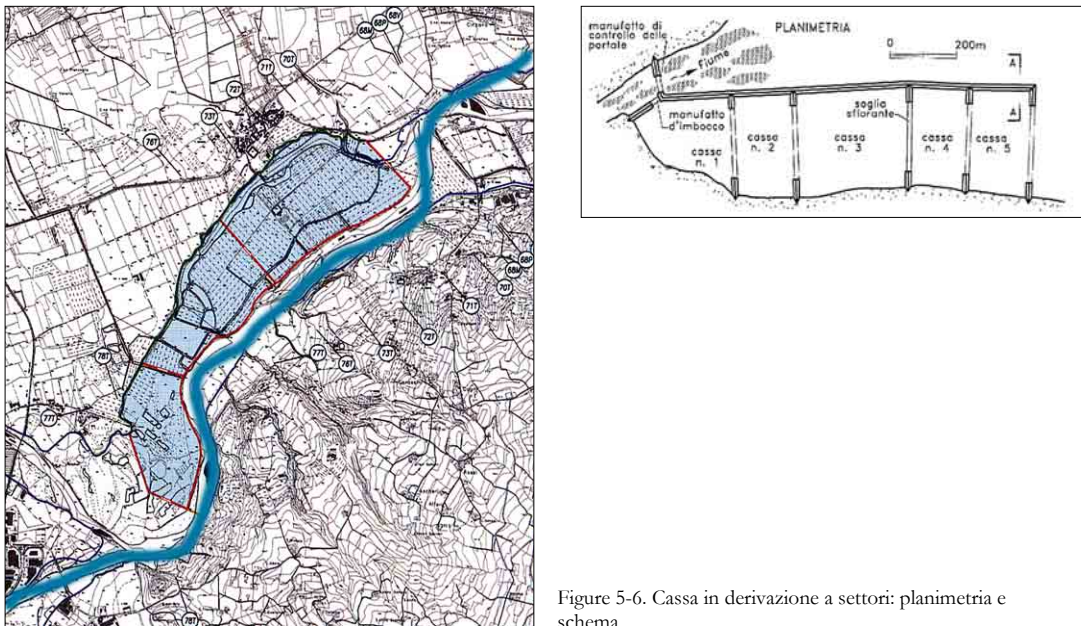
Cassa in derivazione a settori: planimetria e schema.
